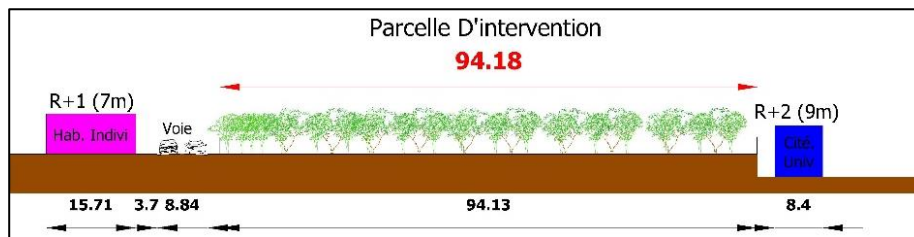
Coupe transversale sur la parcelle d'intervention.
